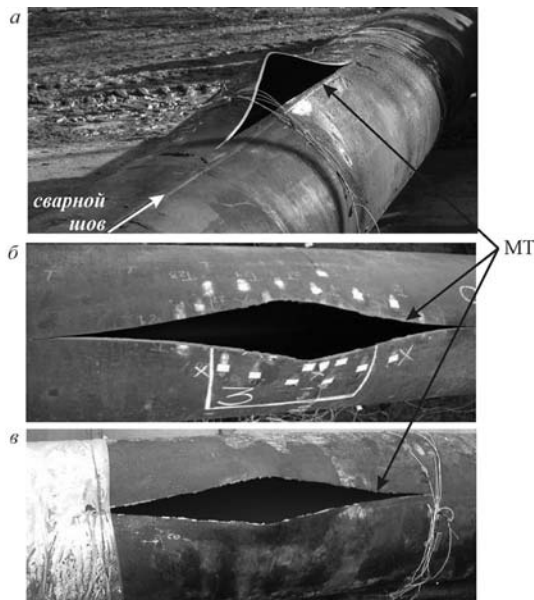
Характер разрушения труб: а — МТ вдоль сварного шва; б — МТ по дну ручейков ЛКП овального типа; в — МТ по скоплению оспообразных повреждений на одном из берегов ЛКП типа полоски (МТ — магистральные трещины)
